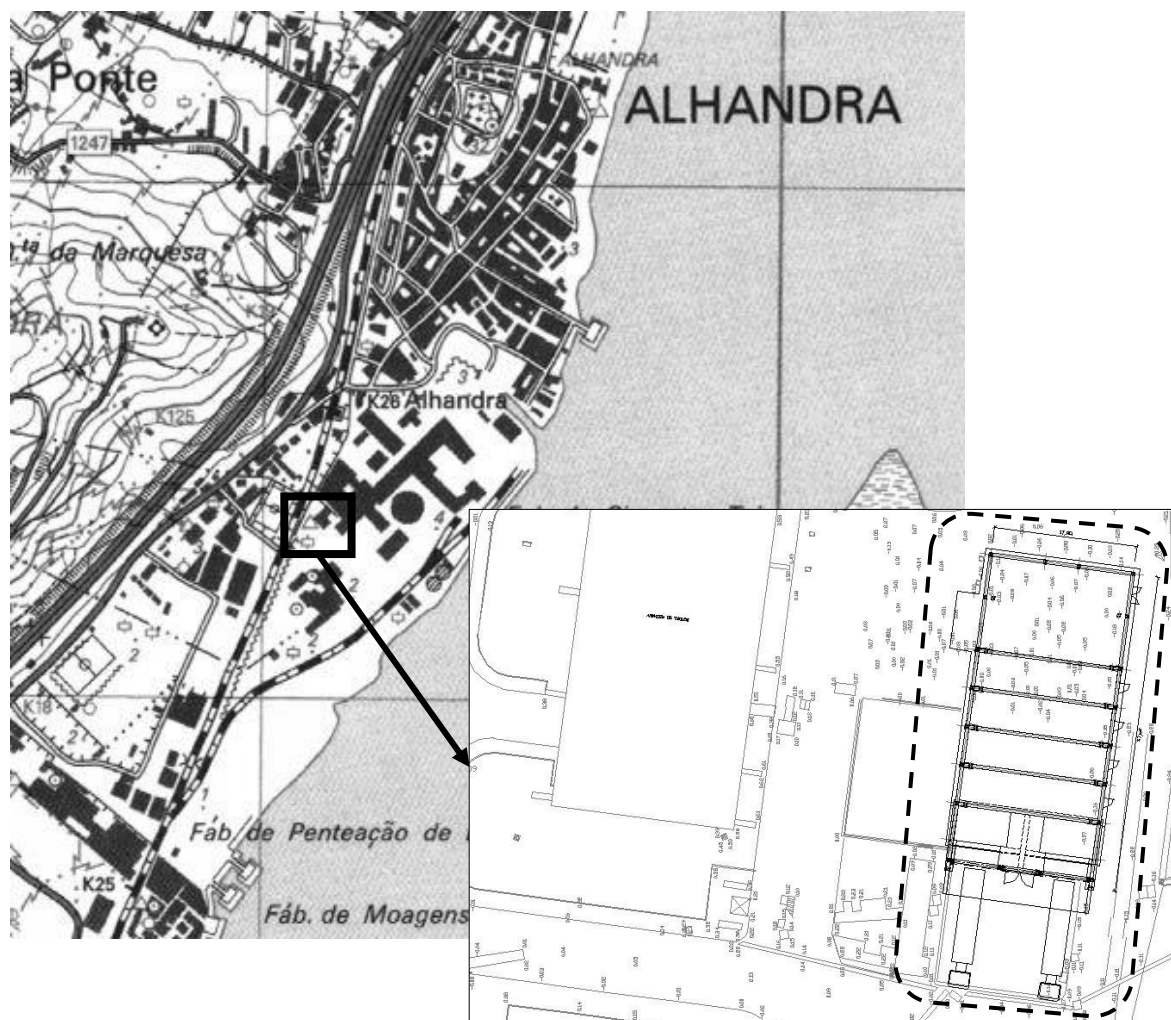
Planta de Localização (fonte: IGeoE)
